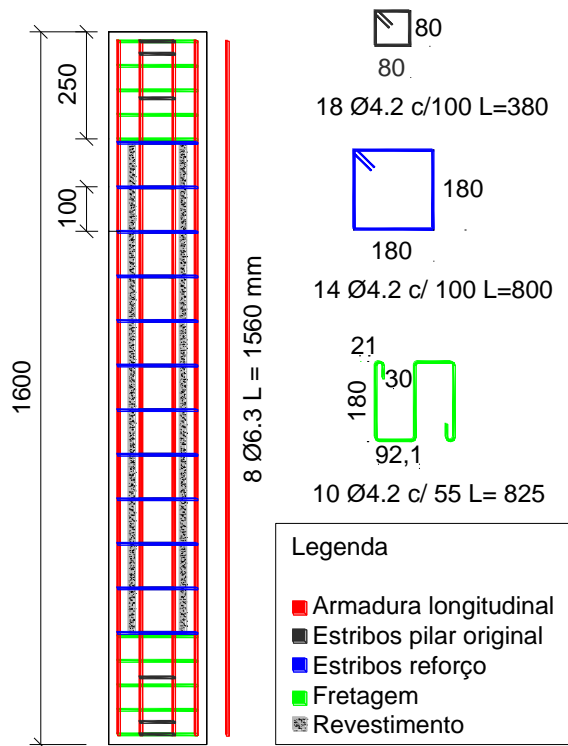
Detalhamento da armadura do pilar PR₁₀₀
